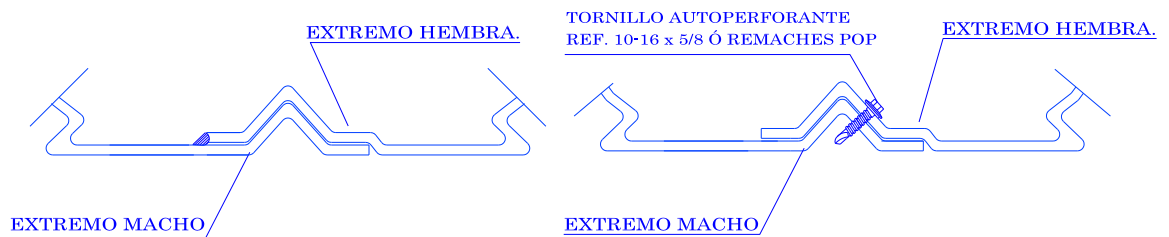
DETALLE TRASLAPO DE LOSA METALDECK.
